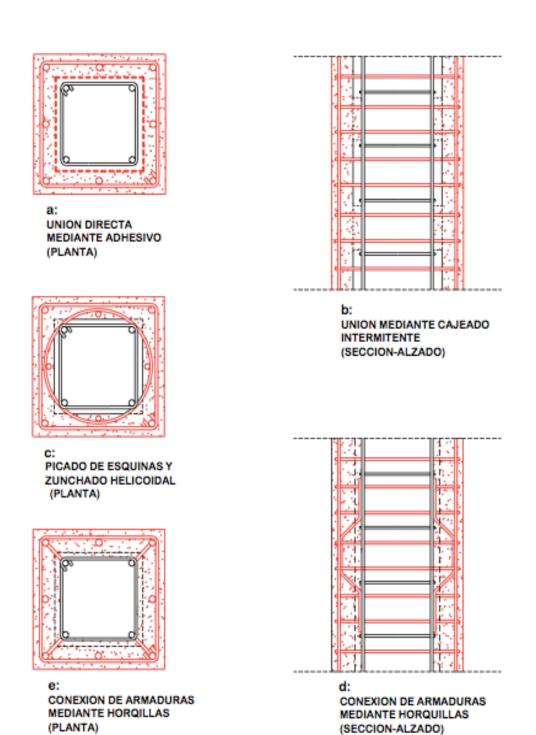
ilustración encamisado de concreto. (Fuente: Patología, reparación y refuerzo de estructuras de hormigón armado de edificación)
